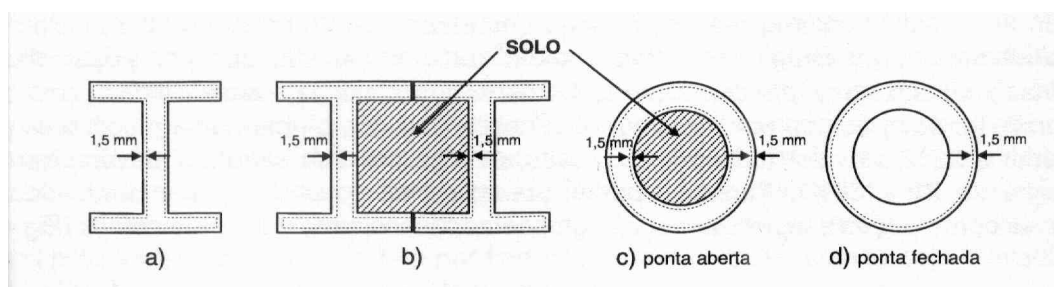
Área útil da seção de estacas metálicas (Presa, E. P.; Pousada, M. C., 2004)
